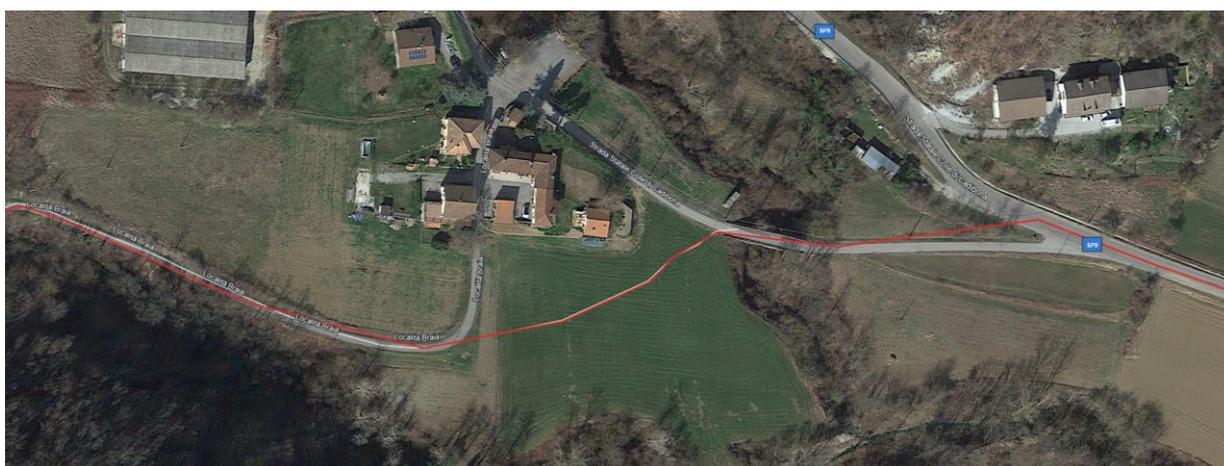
Indicazione concettuale della variante di collegamento fra la SP9 e località Braia
